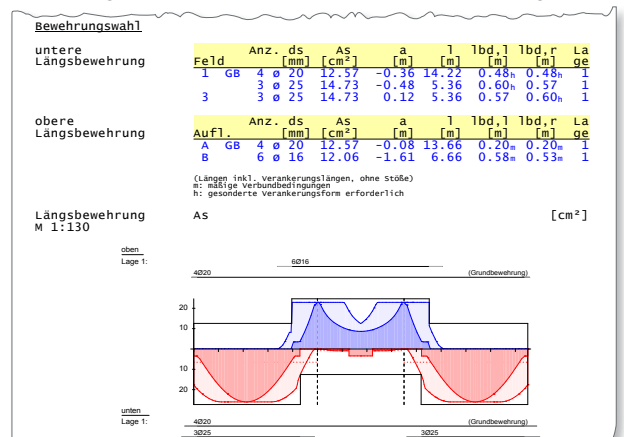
Bewehrungswahl mit Zugkraftdeckungslinie
